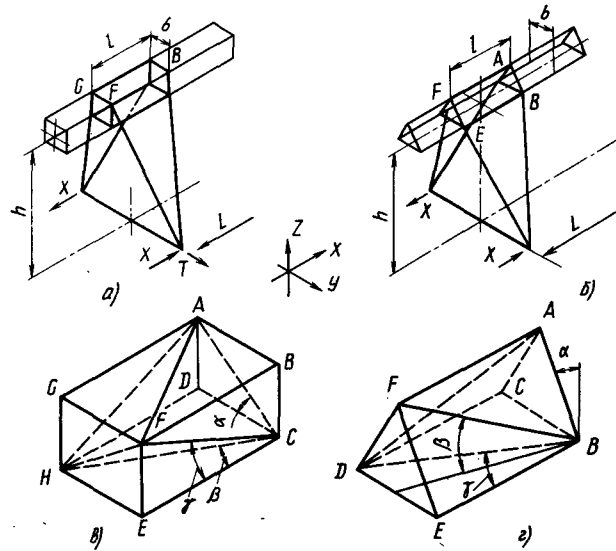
Схемы к расчету надпорного узла решетчатого моста
